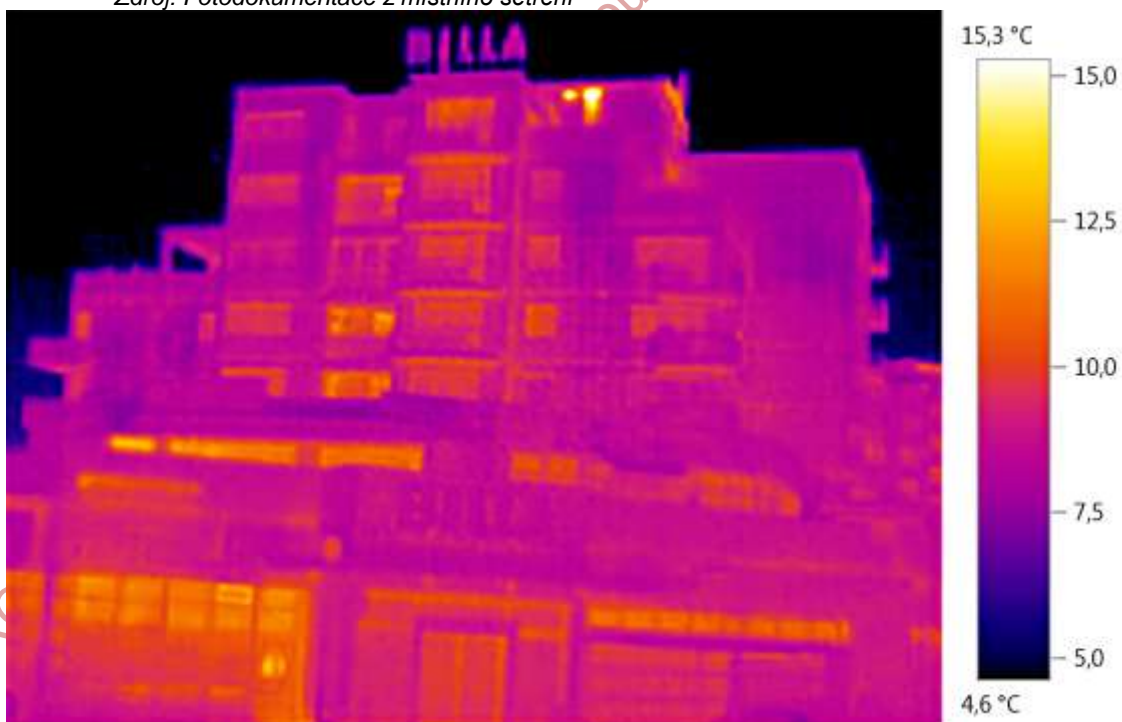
Východní fasáda. Termovizní snímek dokumentující zvýšenou povrchovou teplotu fasády v místech železobetonových stropních ztužidel, sloupů skeletu, ale i vykrakorcovaných balkónů
